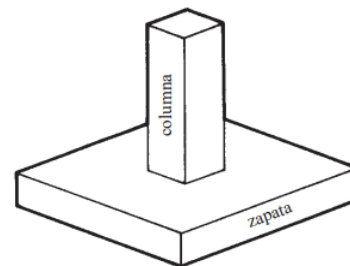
Zapata aislada o zapata para una sola columna (McCormac, J., 2011).
